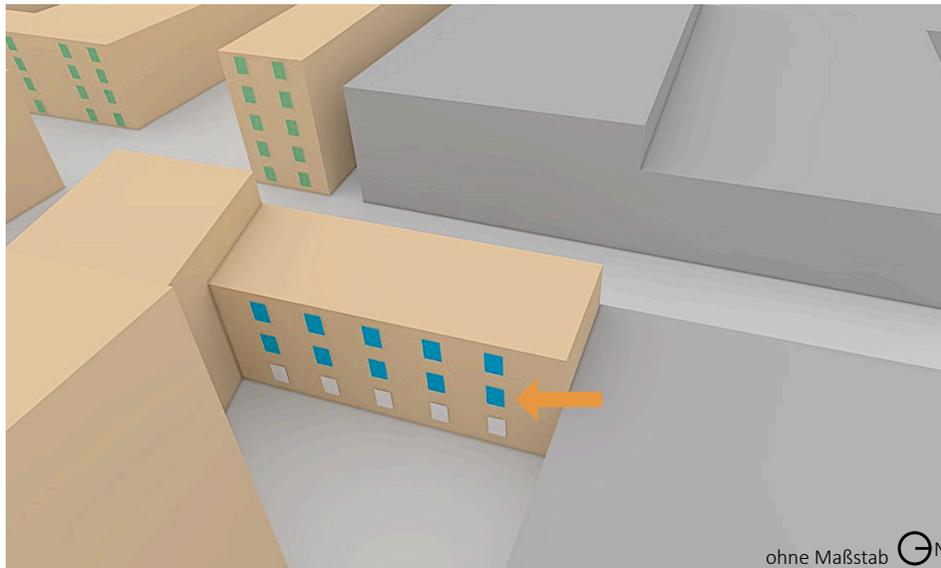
Maßnahmen - QN-BF 5 Ostfassade - Gebäudestand 26.01.2024
